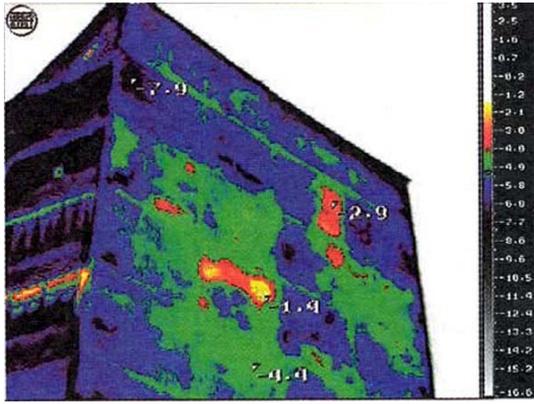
Термограмма стены жилого дома с нарушенной теплоизоляцией панелей (участки красно-желтого цвета)
